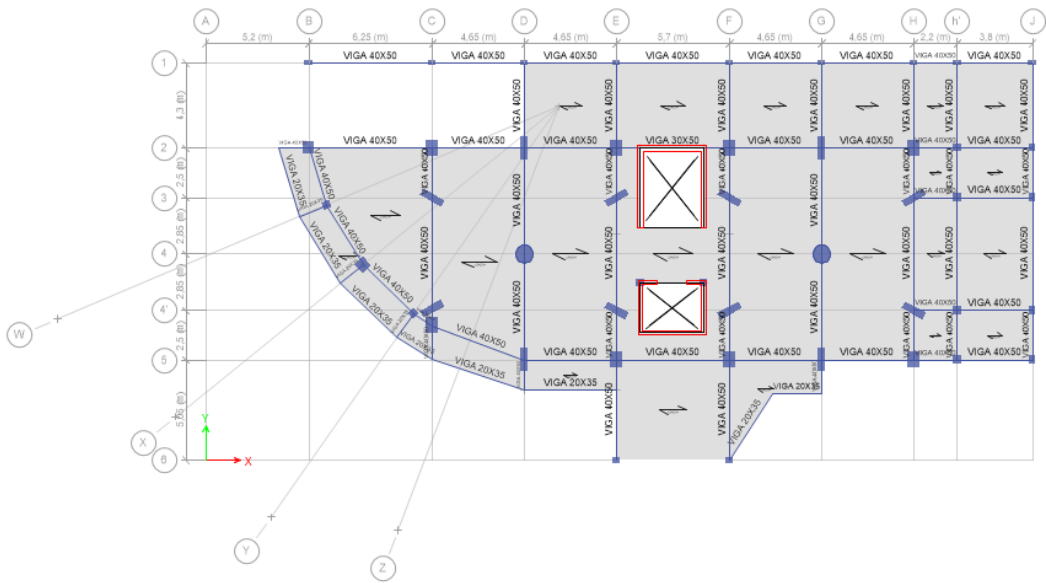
Planta nivel +0.72 m Edificio Silva Núñez
